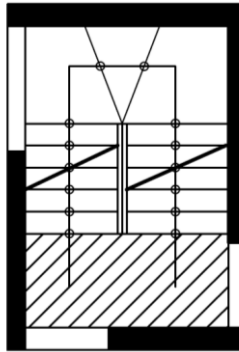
1 Vista en planta de la escalera principal del proyecto (FUENTE: PROPIA)
